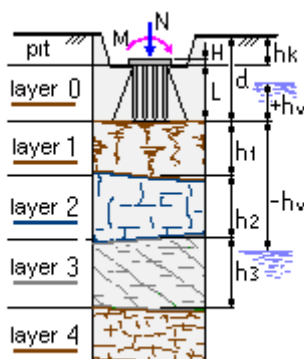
Схема к расчету свайного основания по первому предельному состоянию.
